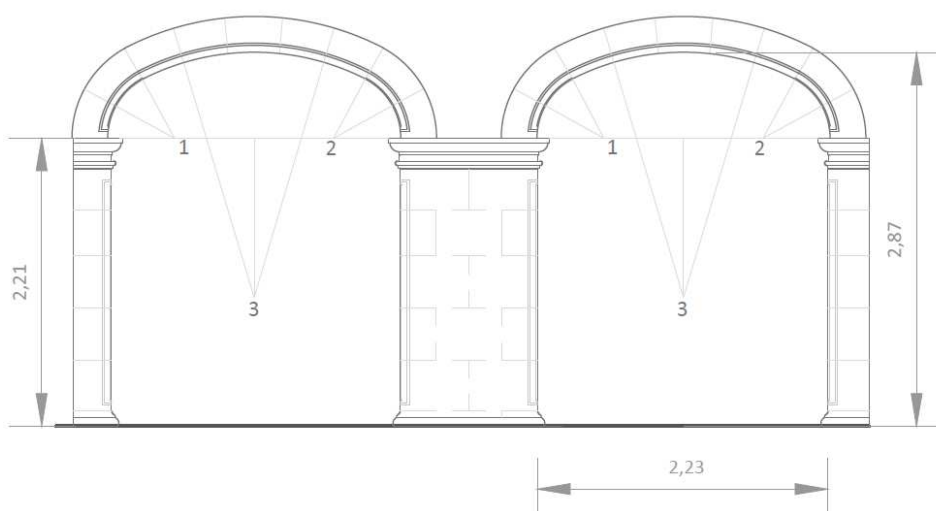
Esquema de arco carpanel situado en planta baja. Elaboración propia
